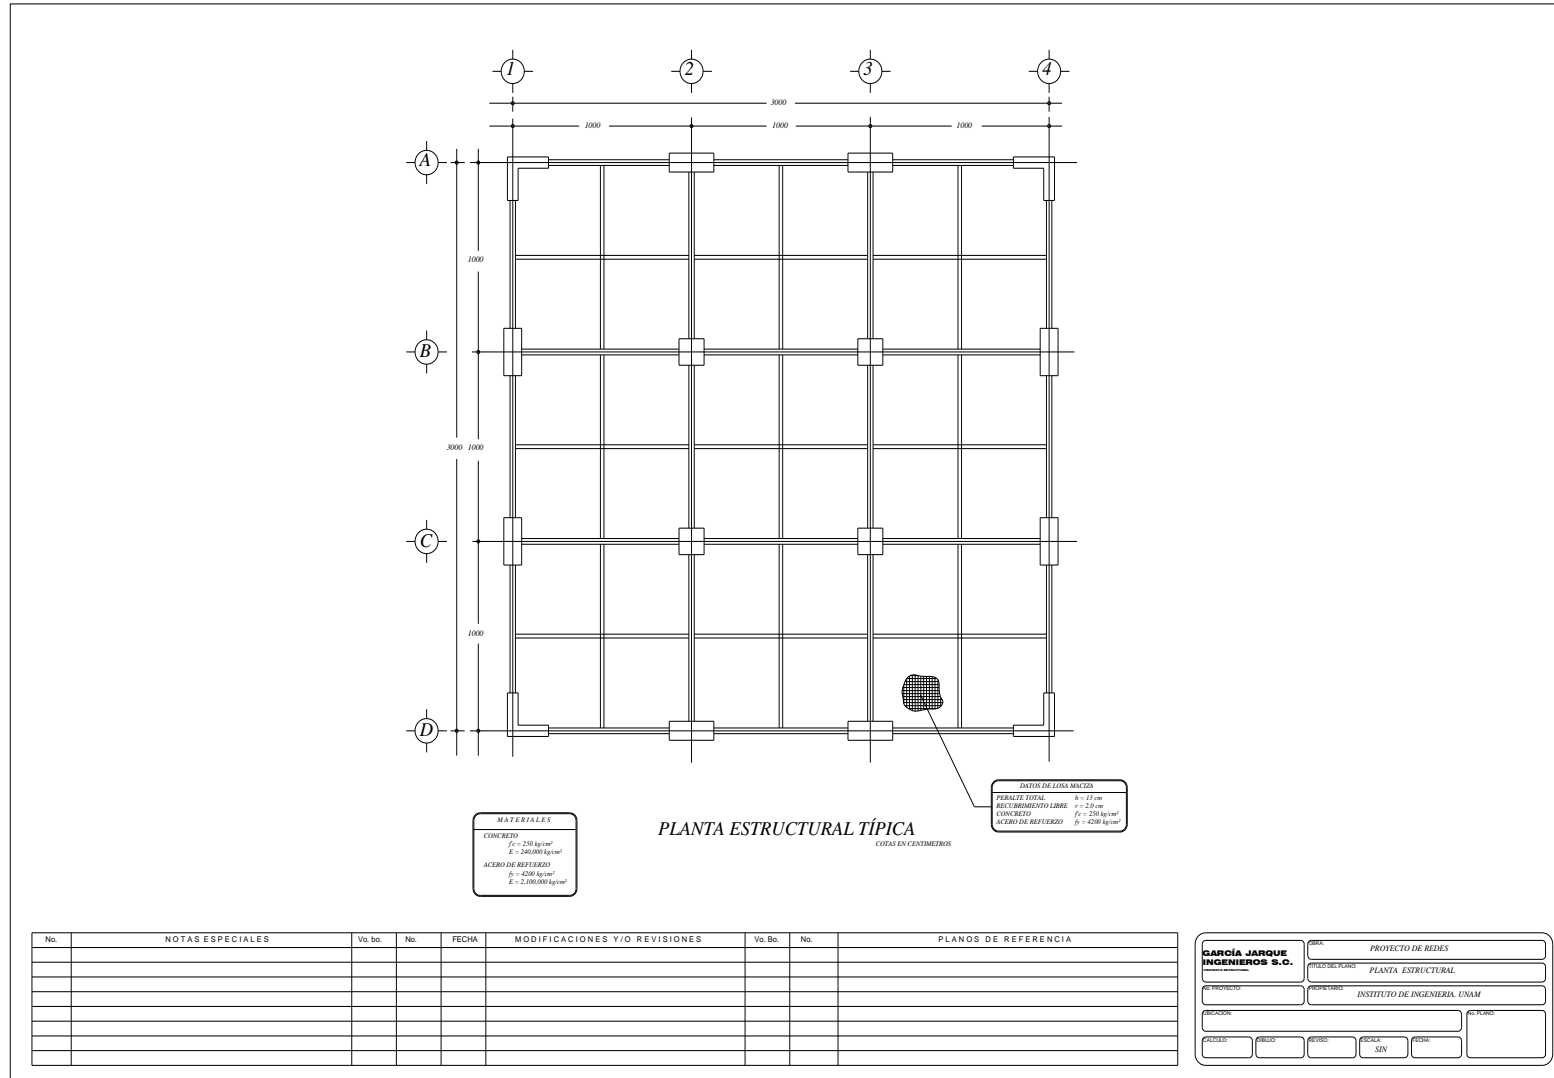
Detalles estructurales del edificio de 10 niveles diseñado con el RCDF-04
